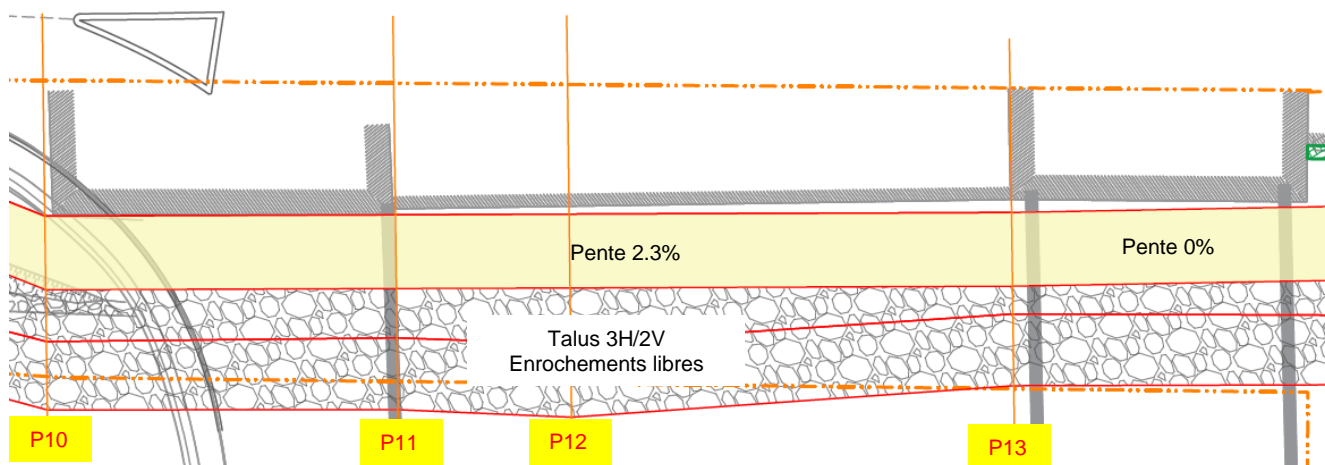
Zone située entre les deux ponts – Vue en plan.
